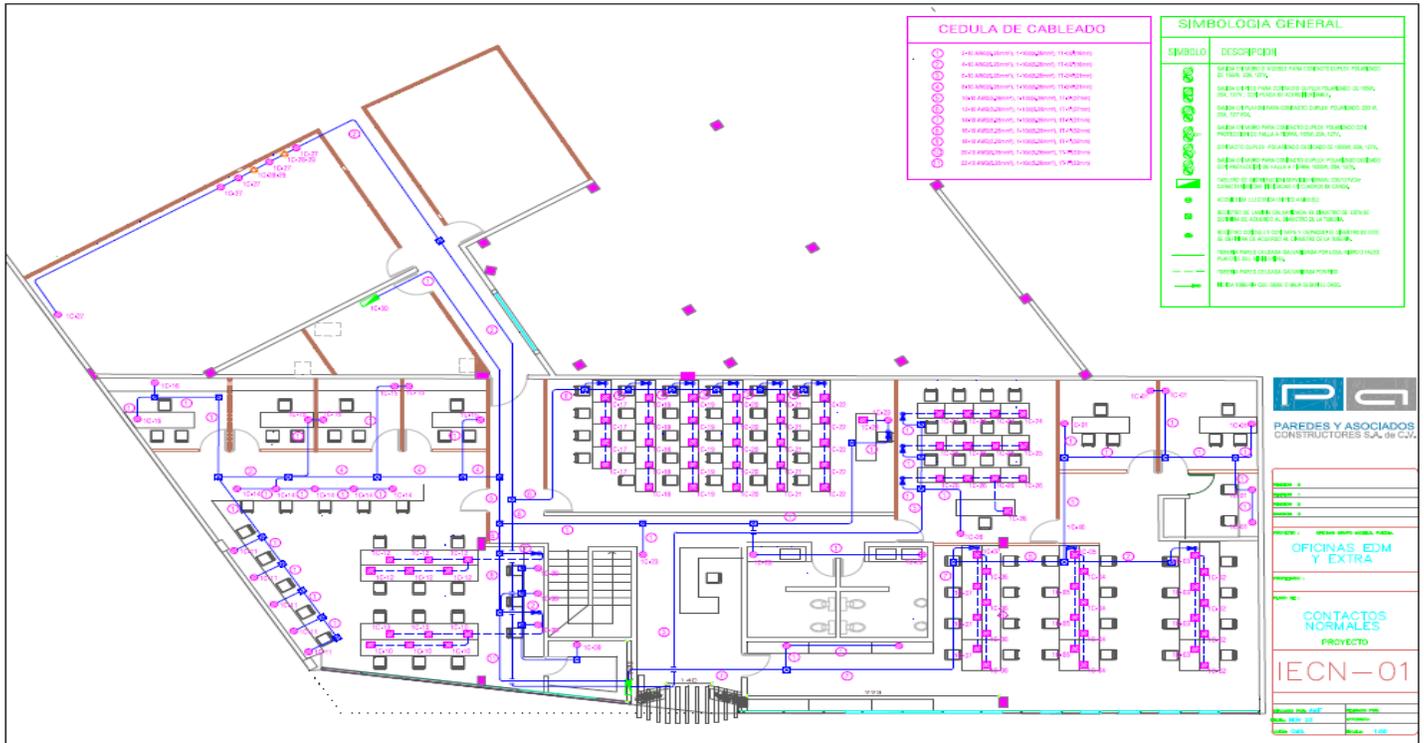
En este plano de planta baja se puede apreciar el acomodo y ubicación de contactos con sus circuitos correspondientes.
